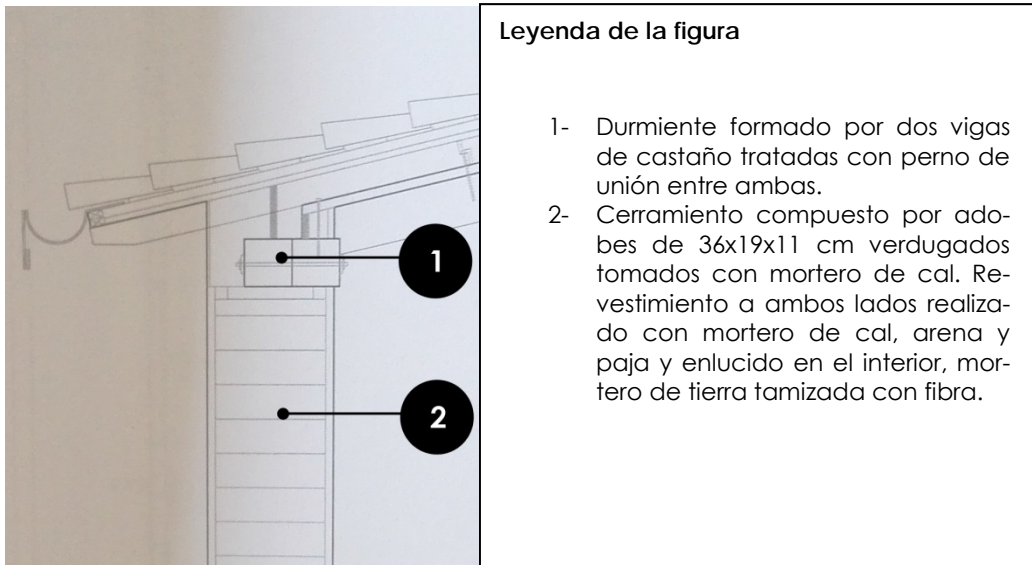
Coronación. SEV-002. Detalle del apoyo de cubierta con muros de carga. Fuente: Autores del proyecto. Elaboración propia.
